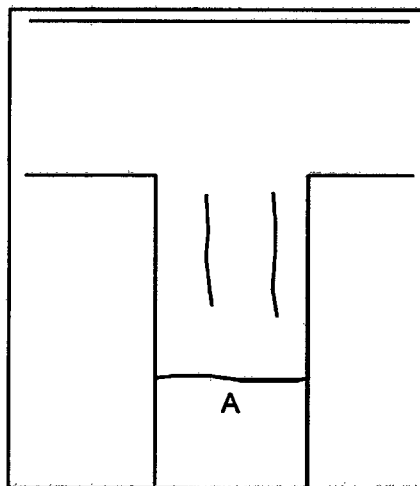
Fisuras por retracción plástica en cabeza de columnas (Pérez, 2008)
